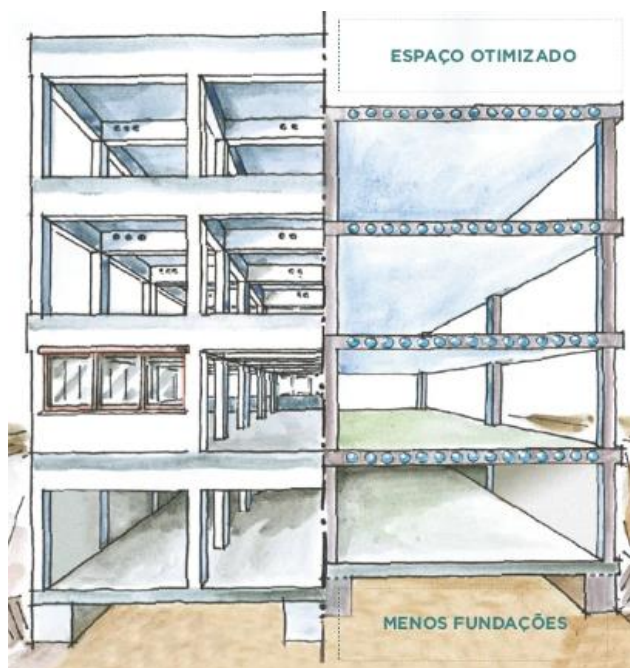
Diferenças entre uma estrutura de lajes vigadas e lajes CBX.
